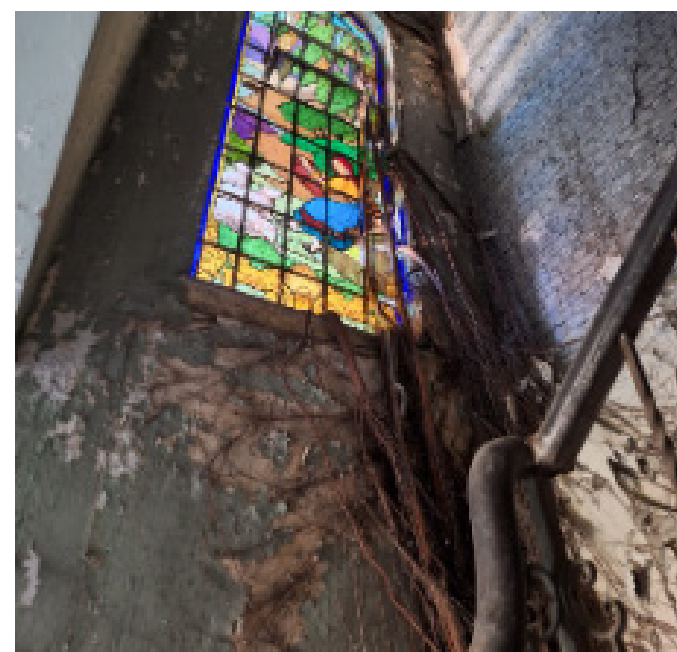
e 9 (acima e ao lado): vistas da fachada dos fundos (norte), onde avistamos à direita vegetação com porte arbóreo voltado para a fachada oeste, ao centro outra voltada para a fachada dos fundos e à esquerda copa de uma árvore que se projeta sobre a edificação.
